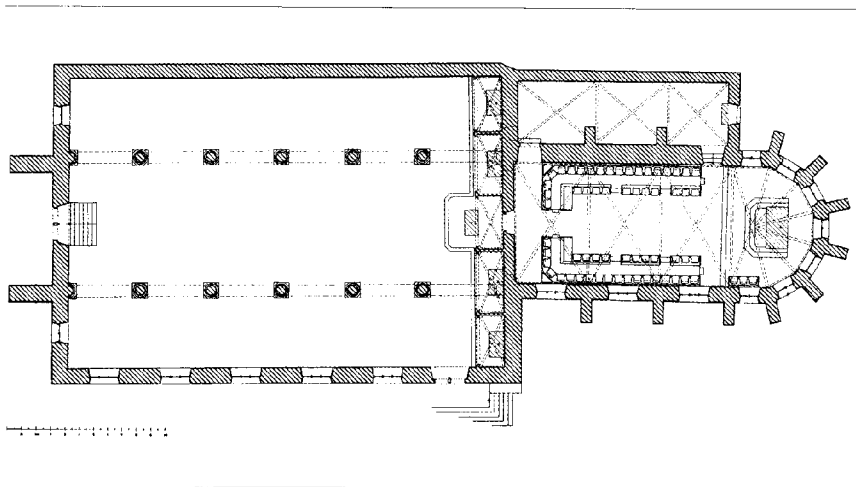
Rottweil, Predigerkirche (1282 geweiht); Grundriss.
